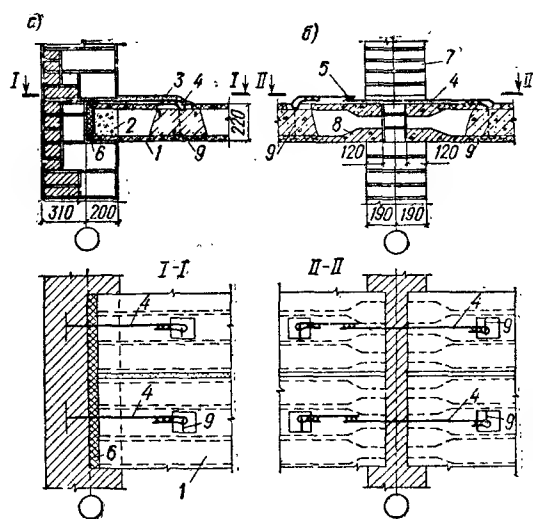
Конструктивные узлы 9-этажного жилого дома с кирпичными стенами
